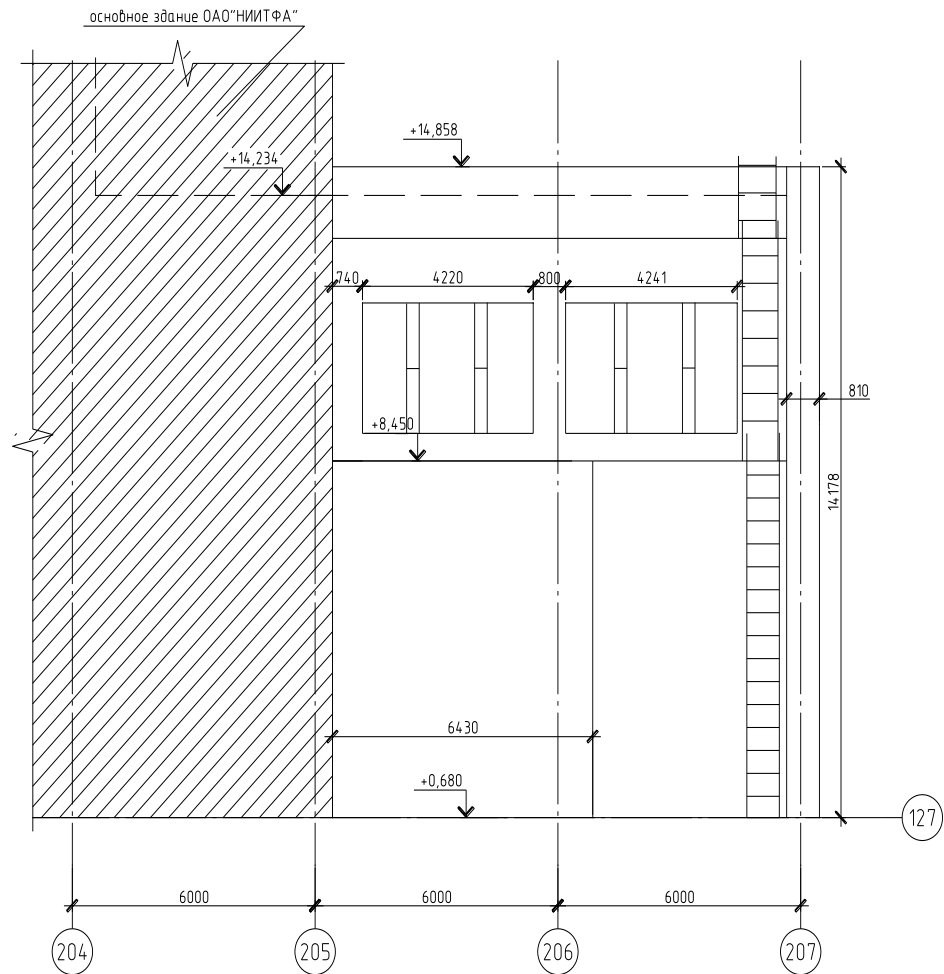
Фасад здания в осях «207-204/124» .
